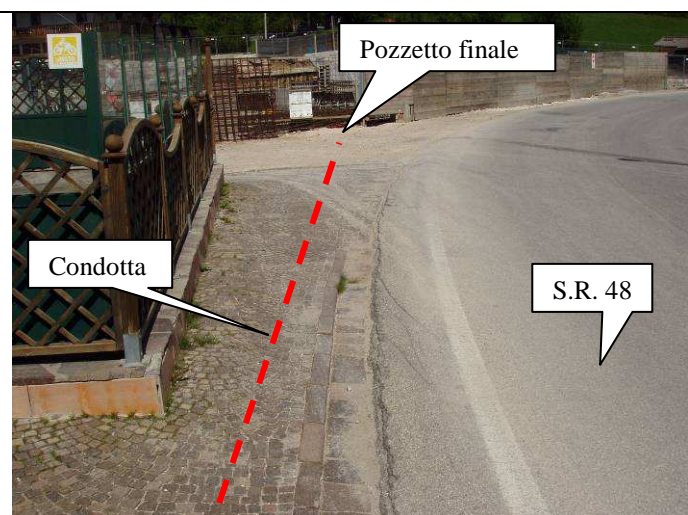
Condotta distribuzione – arrivo al pozzetto finale
